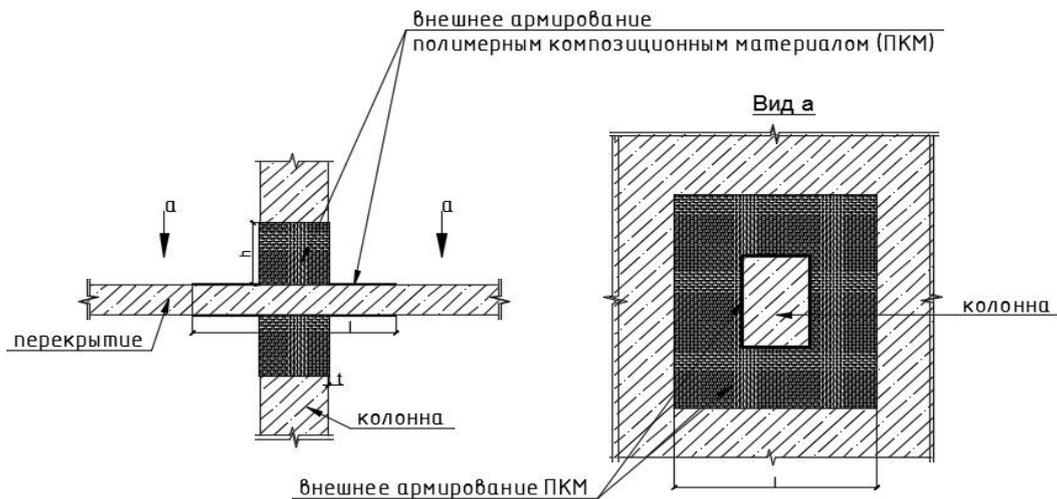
Внешнее армирование углепластиковым холстом соединения перекрытия и колонны
